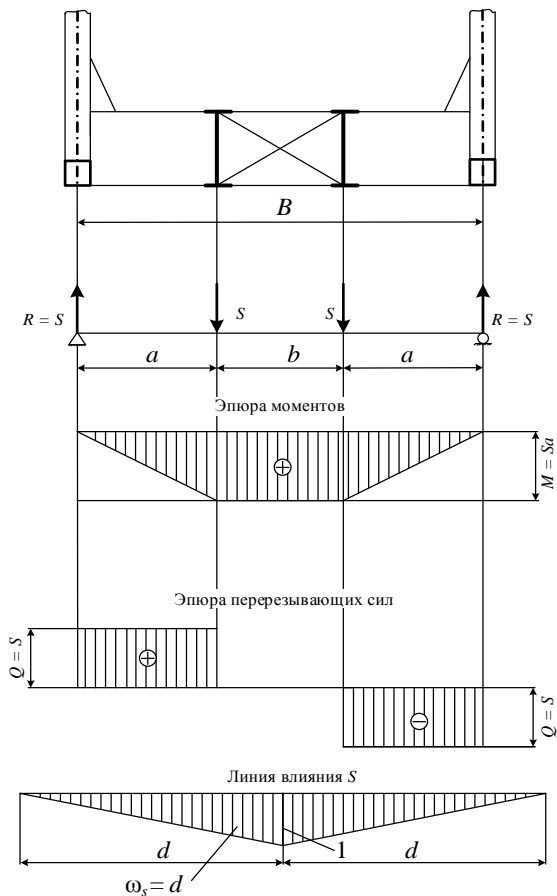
Расчетная схема эпюры усилий для поперечных балок
